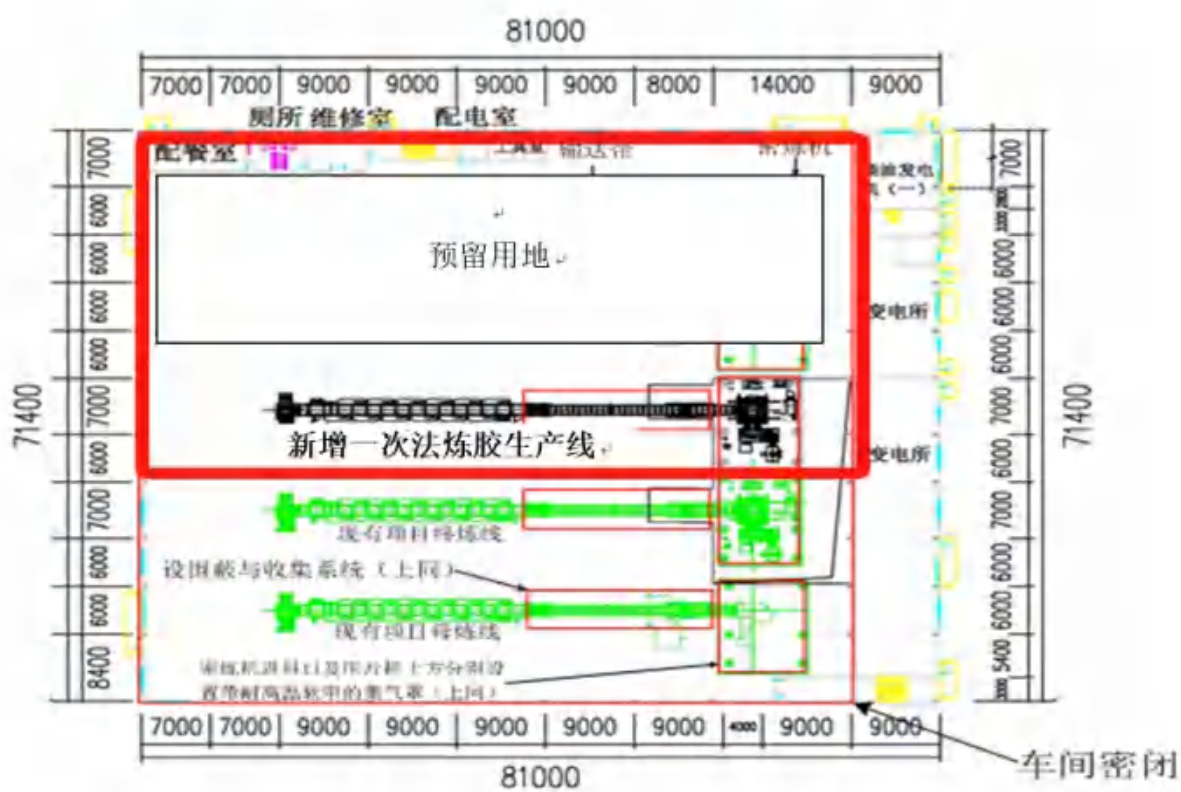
炼胶车间 (二) 1 层平面布局 (局部)
